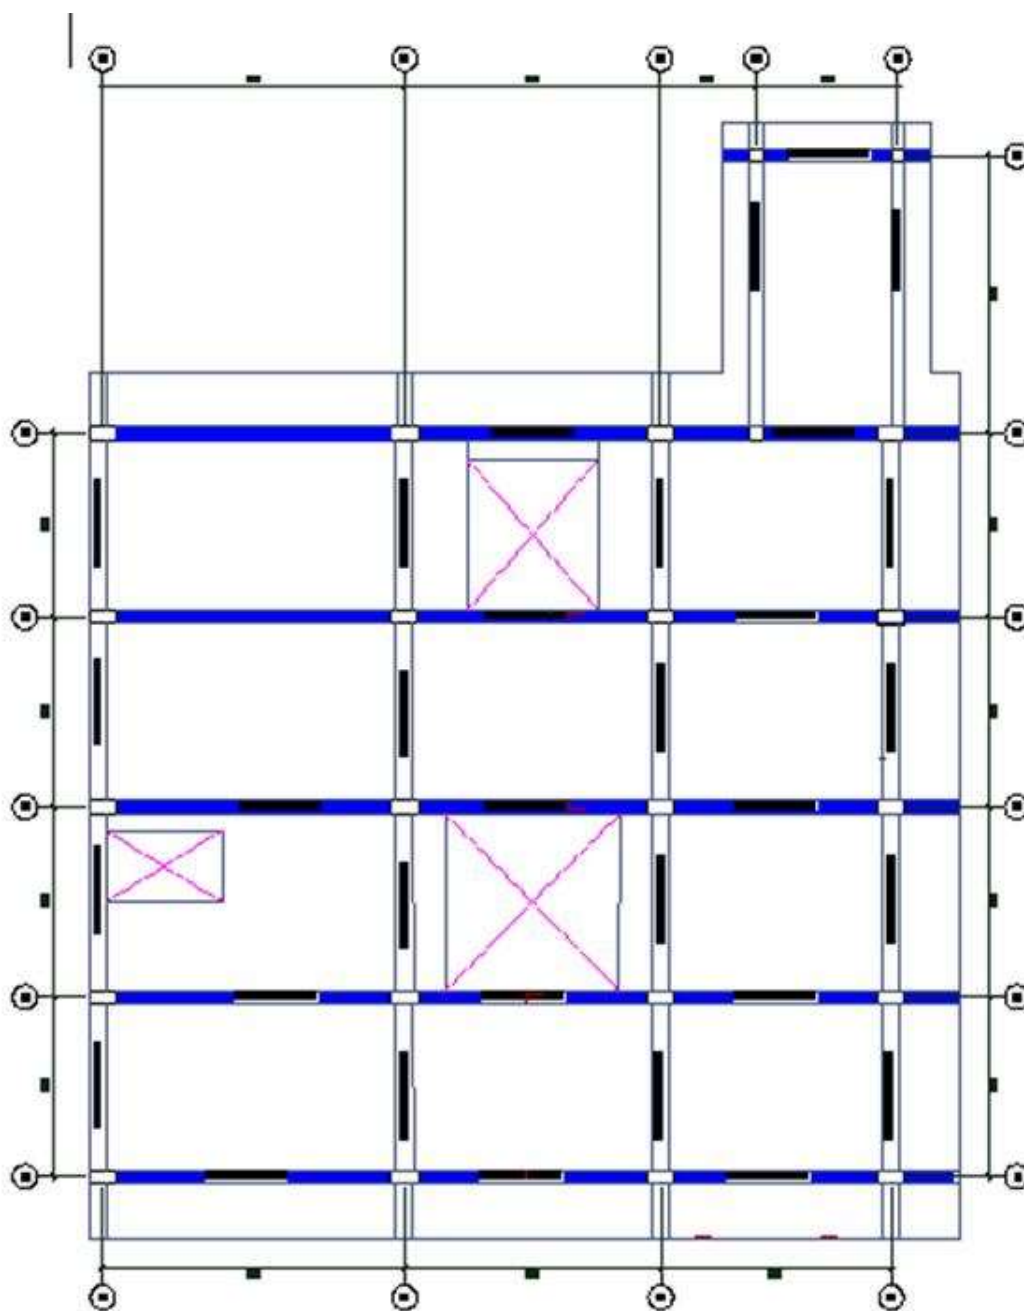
Planta de la estructura de vigas en el Primer Aliegerado.
